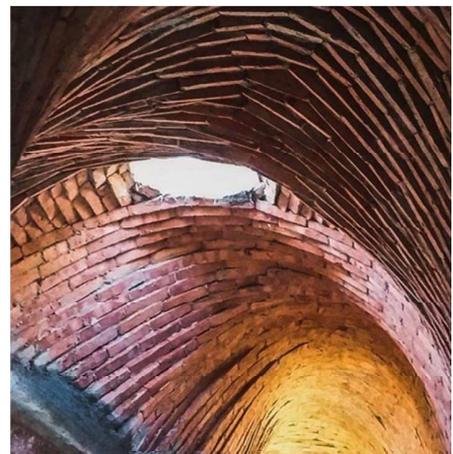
Vista Interior | Fuente: "Debarro Arquitectura"
